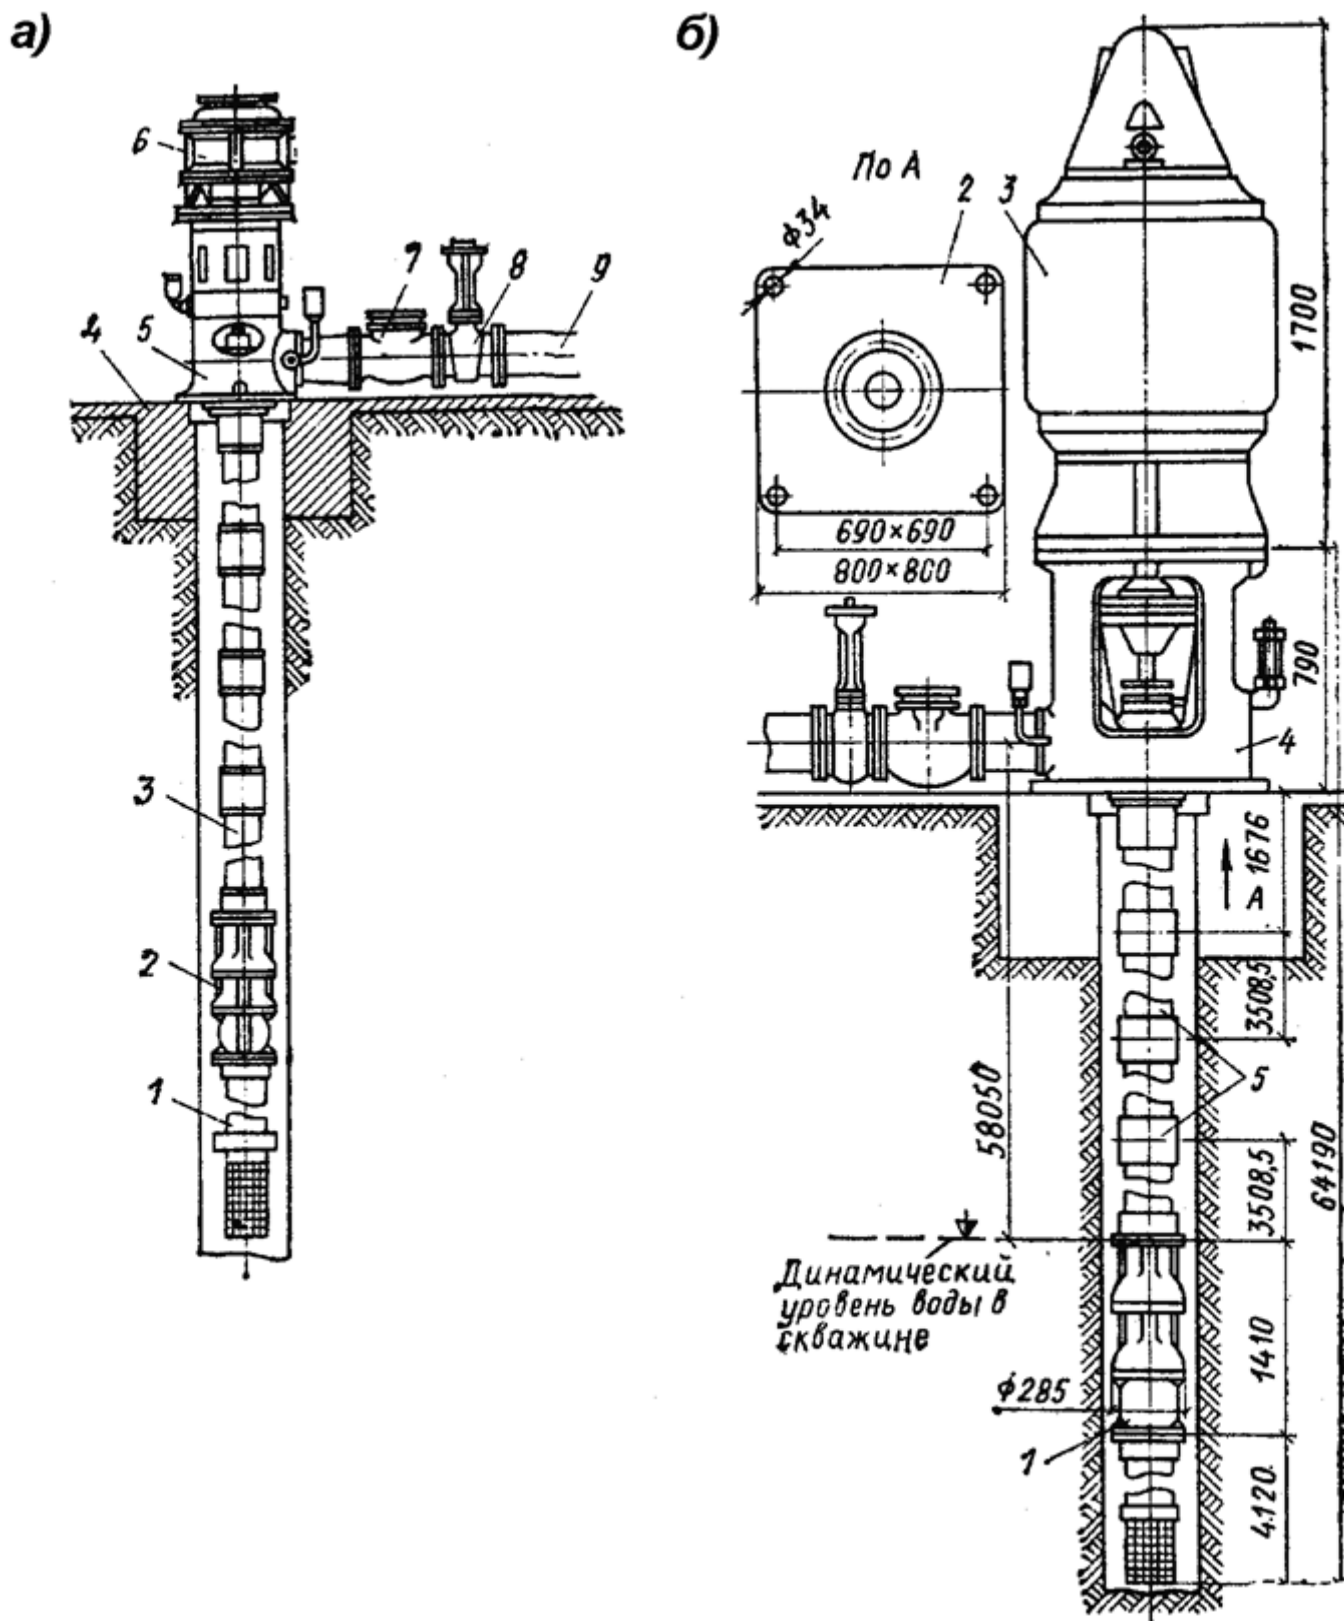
а – установка насоса типа АТН: 1 – всасывающая труба; 2 – насос; 3 – водоподъемная труба; 4 – фундамент; 5 – станина; 6 – электродвигатель; 7 – обратный клапан; 8 – задвижка Лудло; 9 – водоотвод; б – установка насоса типа А: 1 – насос; 2 –
